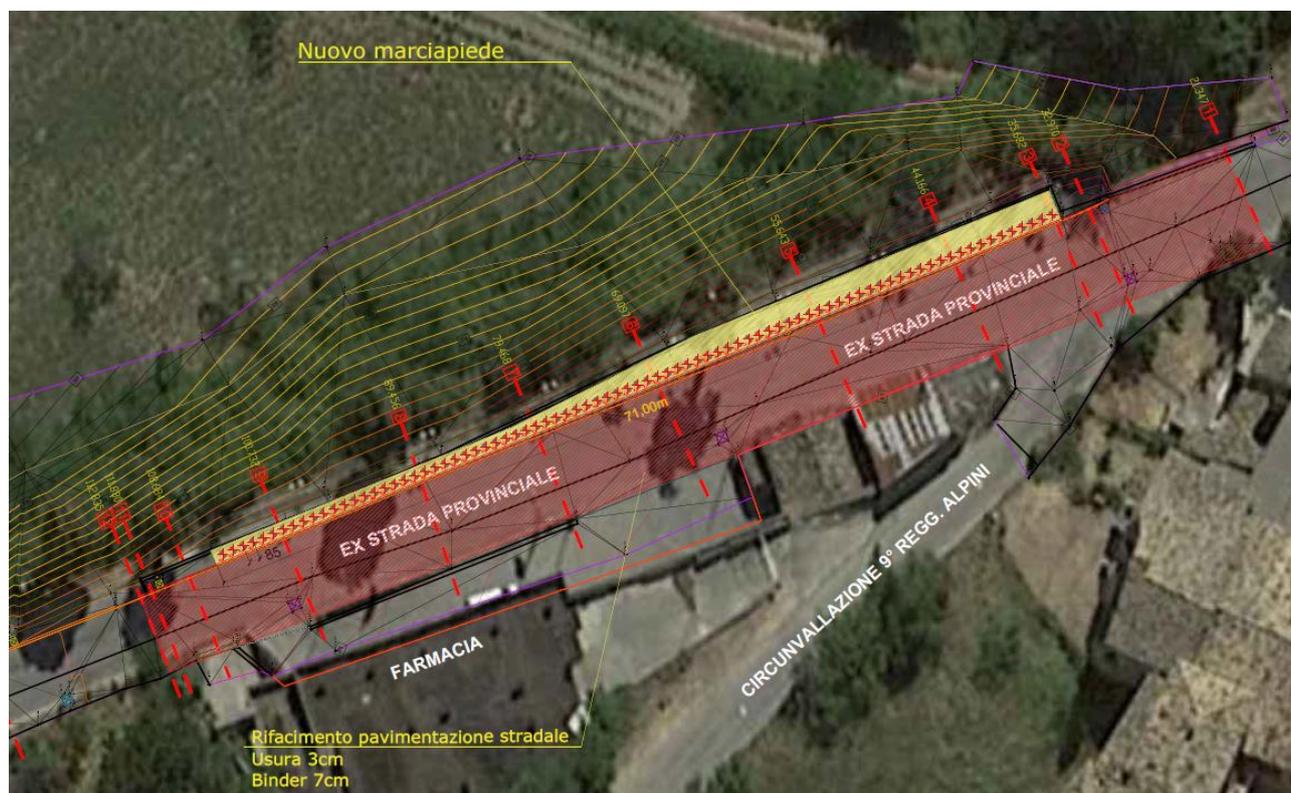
Planimetria stato di progetto (vedi elaborato 14_TG03)
